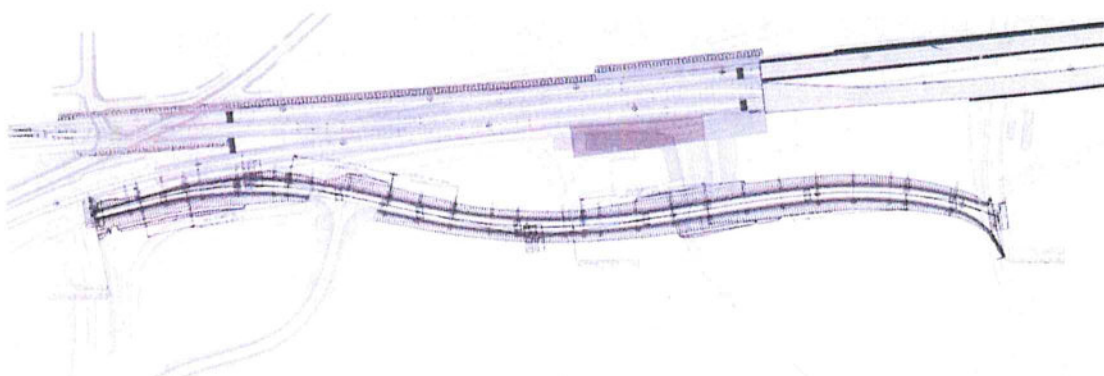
Stralcio planimetrico su rilievo Via della Spianà temporanea.
